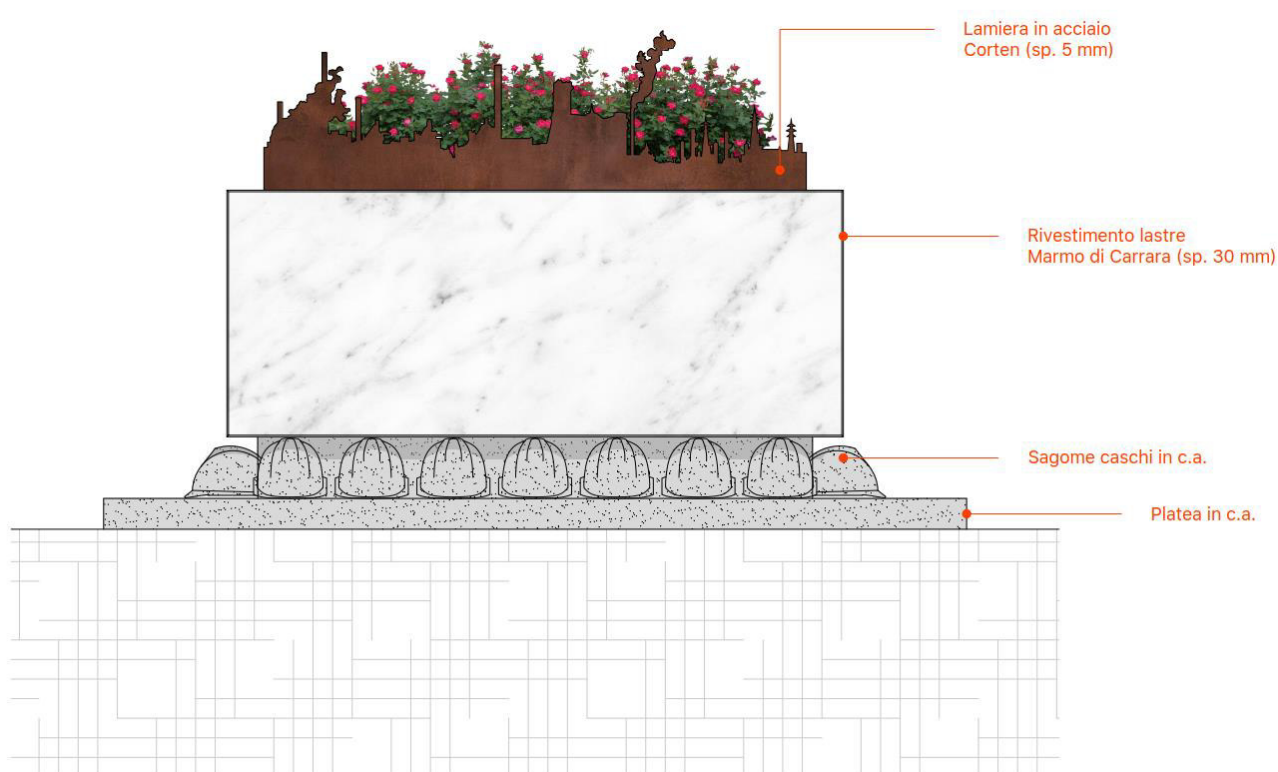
| Prospetto EST/OVEST – Indicazione dei materiali utilizzati in progetto
